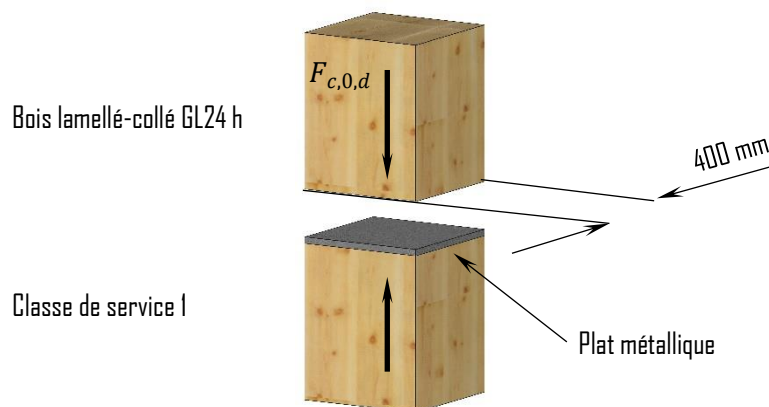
Assemblage par contact métallique d'un poteau de structure de section 400 x 400 mm en bois lamellé-collé GL24h
